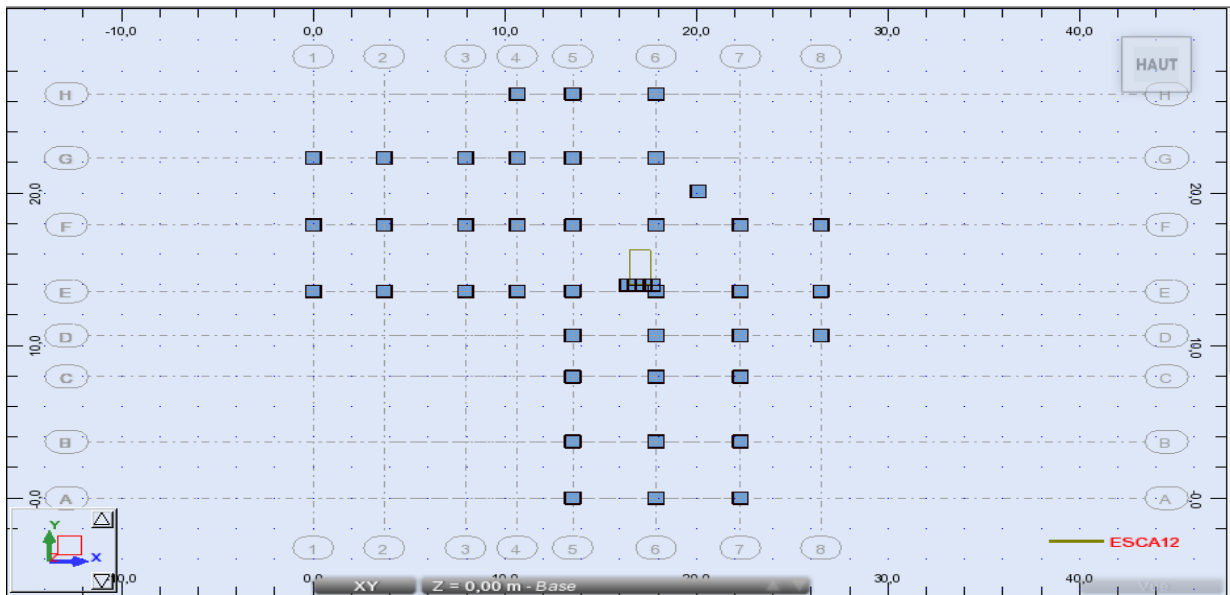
La 1ère disposition des murs voiles et poteaux
